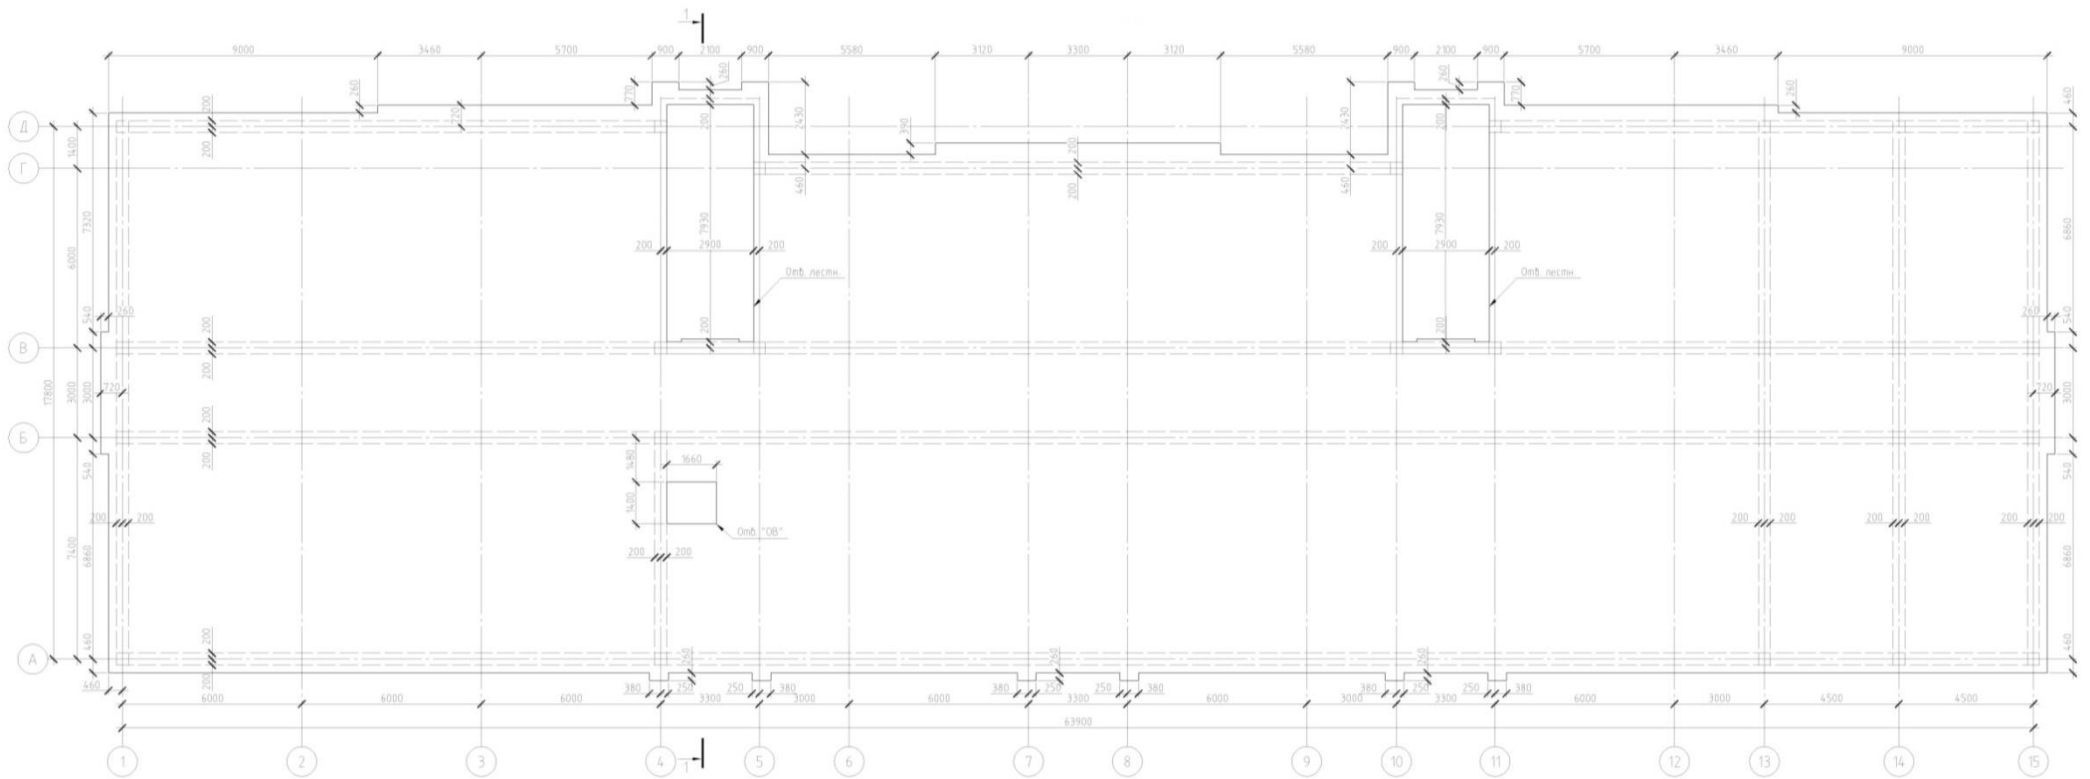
Схема расположения монолитной плиты перекрытия на 2-м этаже (низ на отм. +6,900). Схема расположения монолитных балок плиты
